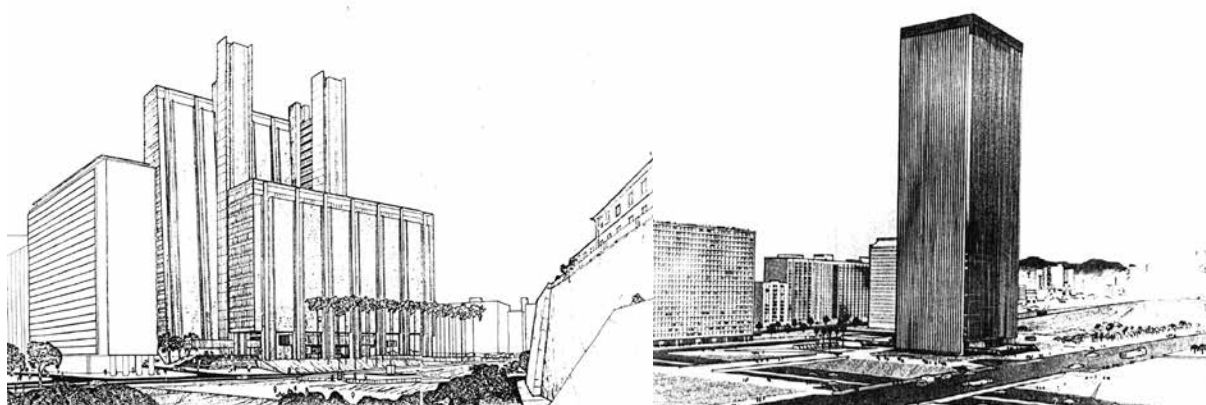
David A. B. Ottoni e Dacio A. B. Ottoni. Duas lâminas paralelas e interligadas por duas torres de elevadores independentes. A torre menor seria complementada em uma segunda fase de obra.
